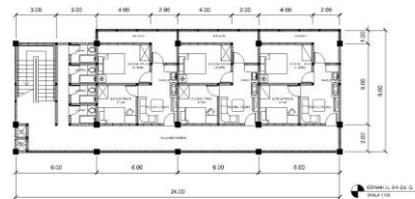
Denah Lantai 2-4 Blok D dan E (tipe sama)
